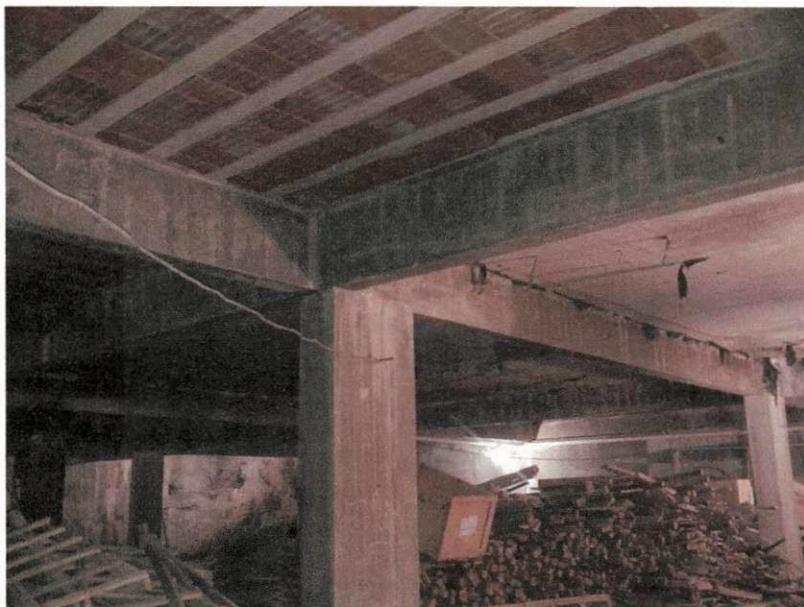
Detalhe das lajes maciças e pré-fabricadas no subsolo do Edifício Portal da Serra.
